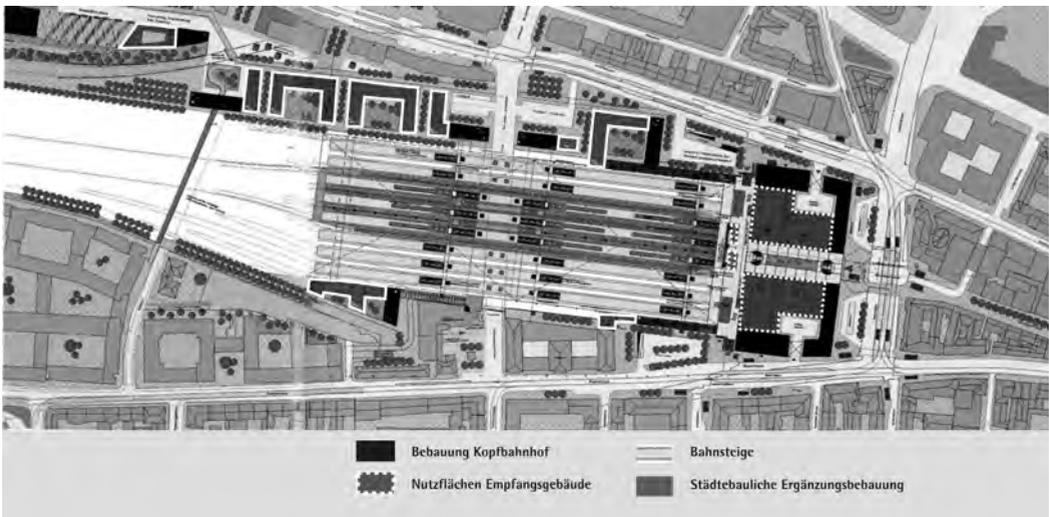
Grundrisslayout Hauptbahnhof – Alternative B (sw-Überarbeitung/Hervorhebungen: Forum Stadt).
